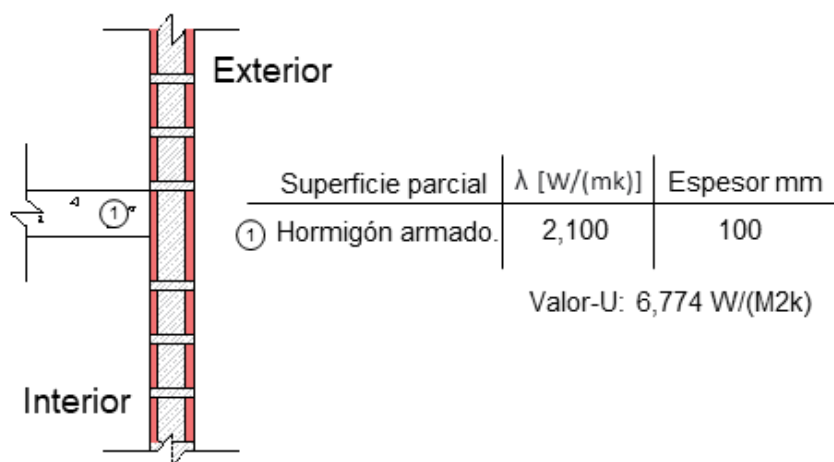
Detalle de elementos constructivo de losa entrepiso. Fuente: elaboración propia.
